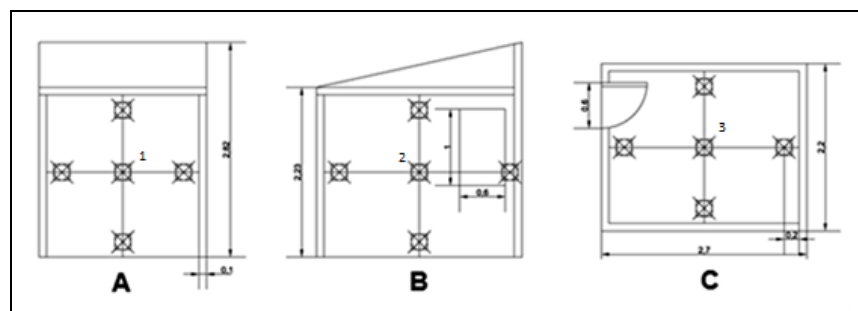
Distribuição dos termopares (sem escala). A- Fachada Oeste. B- Fachada Norte. C- Teto. Fonte Gallardo (2017) adaptado.
